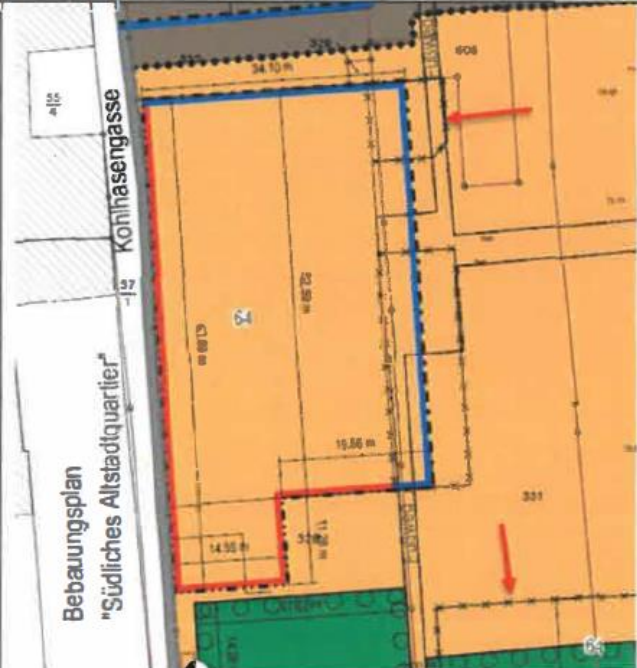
Auszug Planzeichnung Bebauungsplan 20
